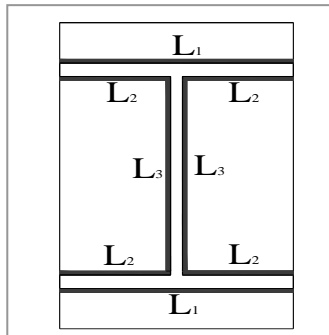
Assemblage soudé poutres –platine.
